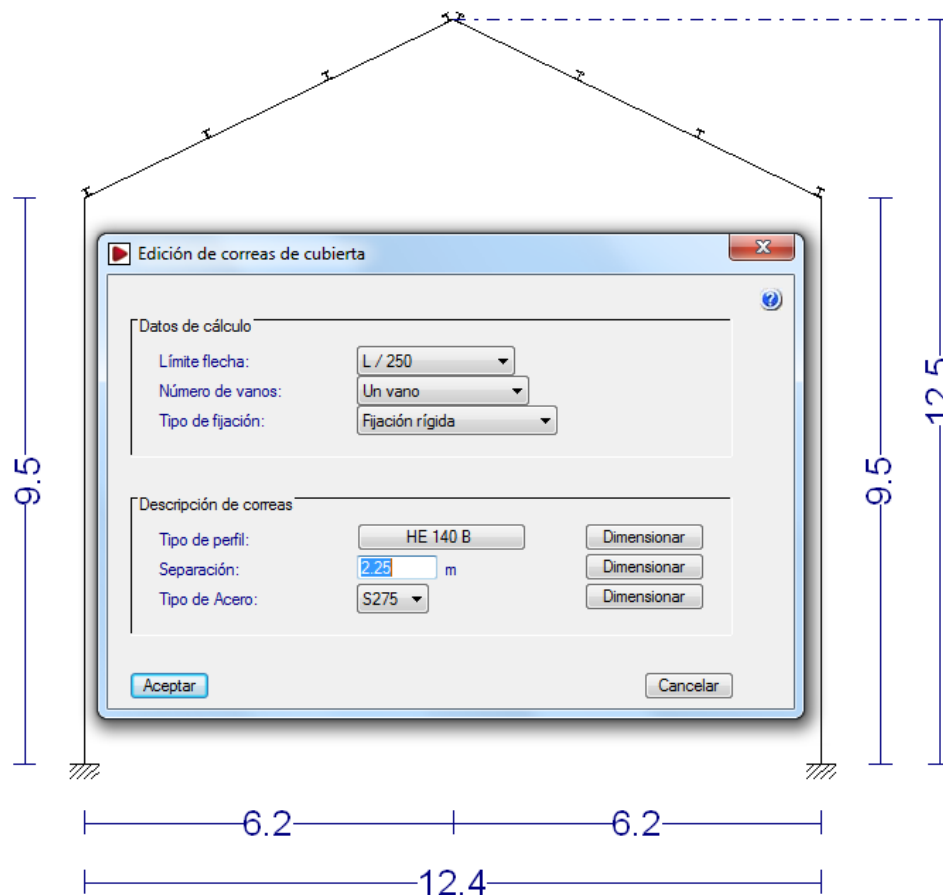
Cálculo de correas en cubierta con perfiles laminados HEB
